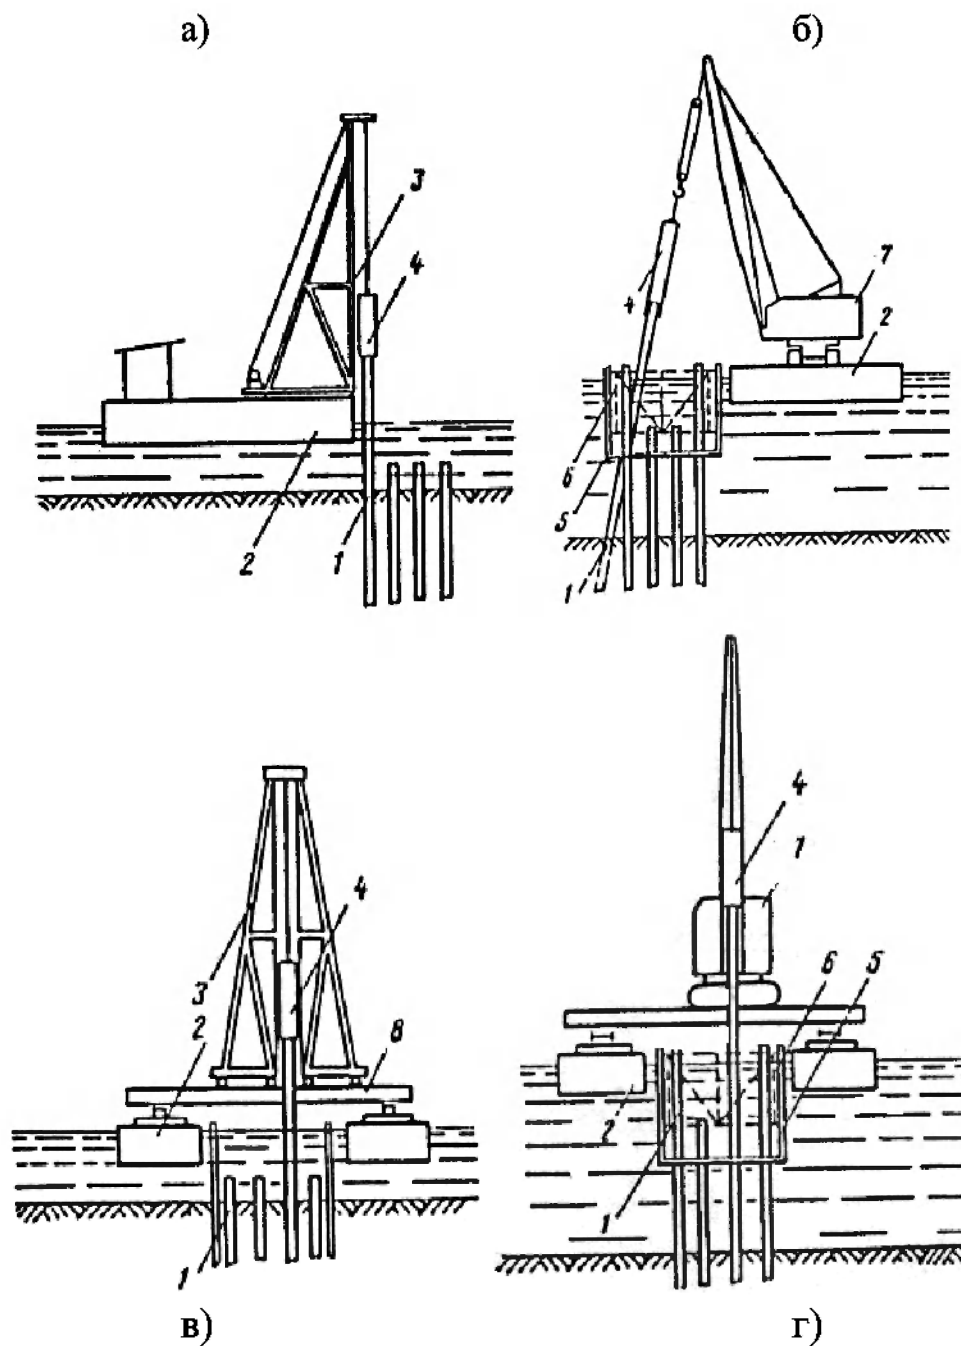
Использование плавучих средств для производства работ по сооружению фундаментов:
